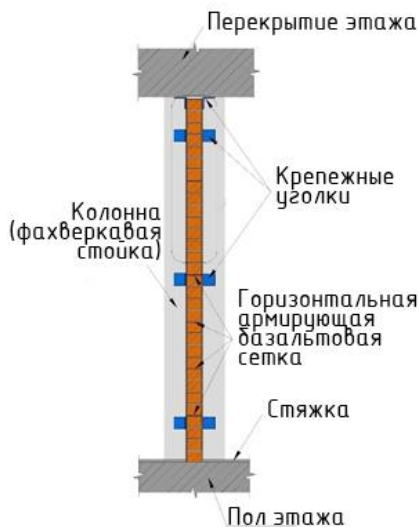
Схема крепления перегородки из различных стеновых материалов, усиленной композитной сеткой, к каркасу здания при толщине перегородки до 25 см
